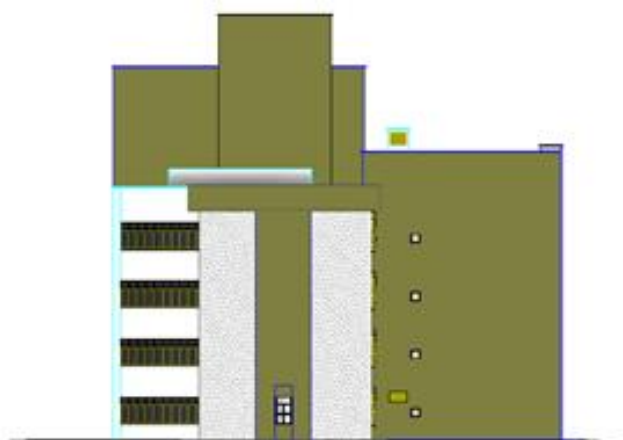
Imagem projeto arquitetônico fachada Leste em *Autocad*.
